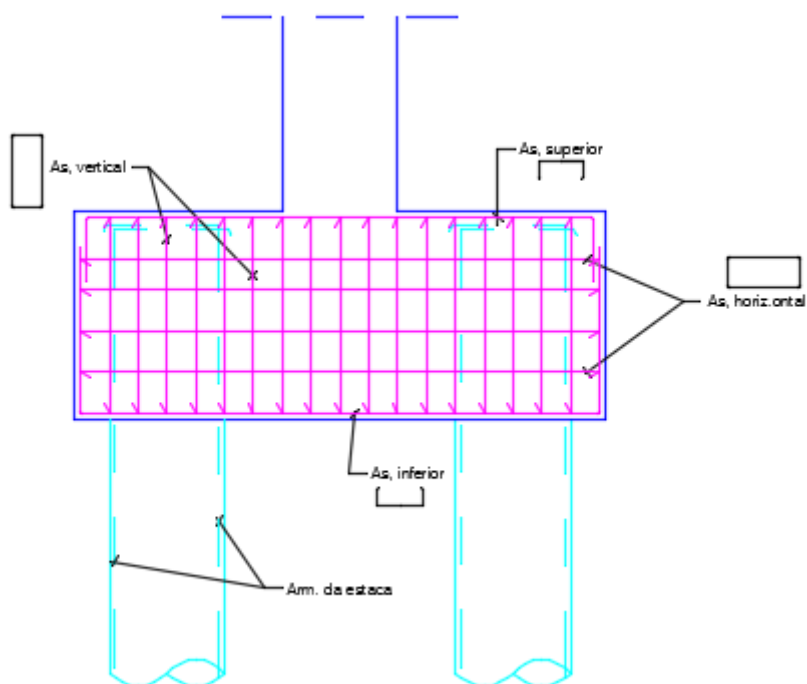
Disposição construtiva das armaduras. (Pouca, 2016)
